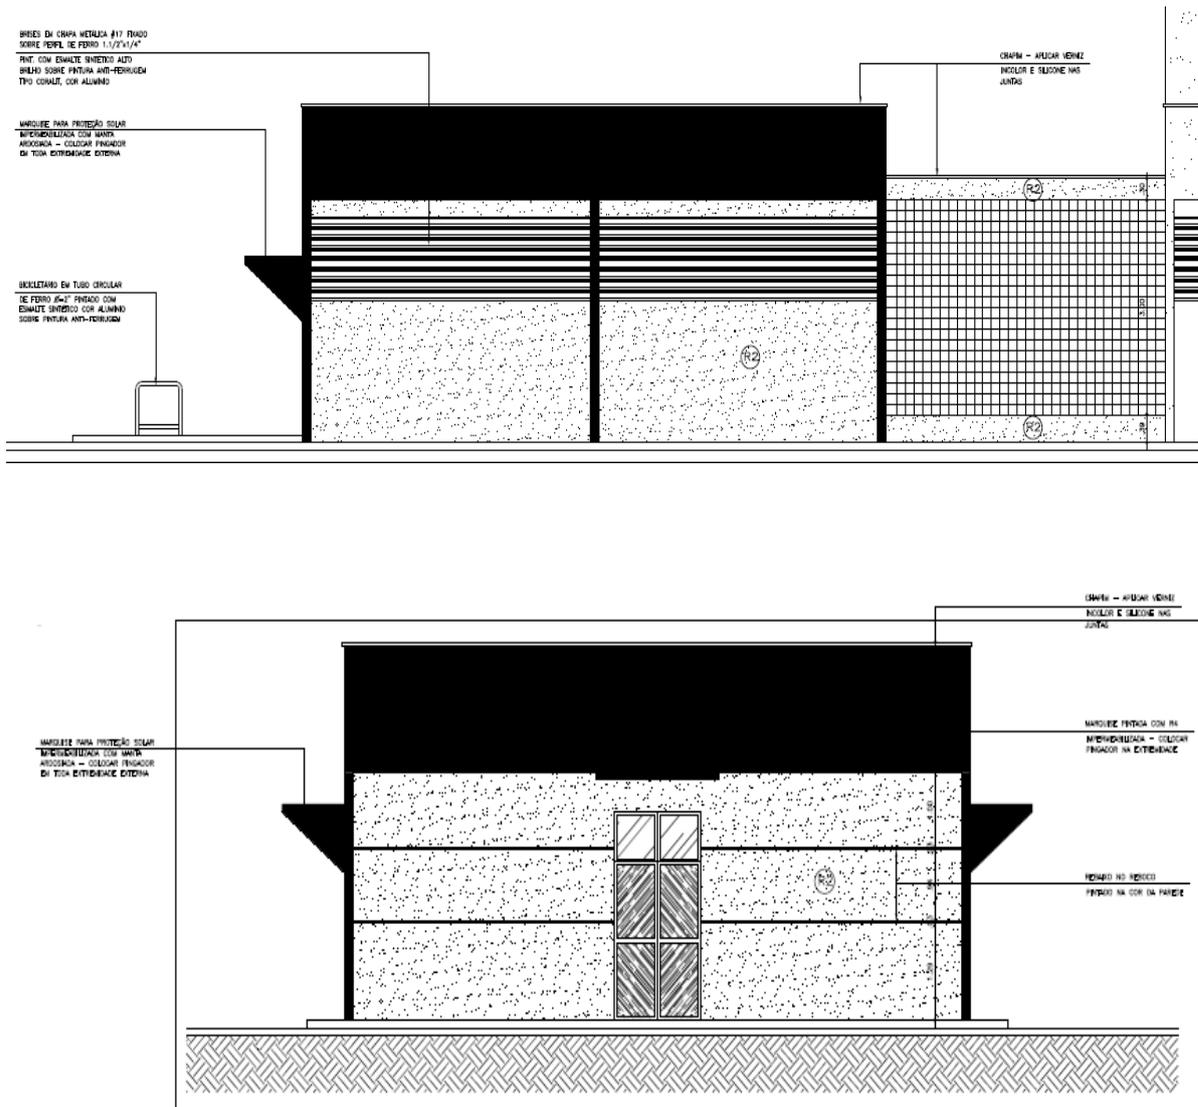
Fachadas do projeto final do estudo de caso. (Fonte: COP/UFC)
